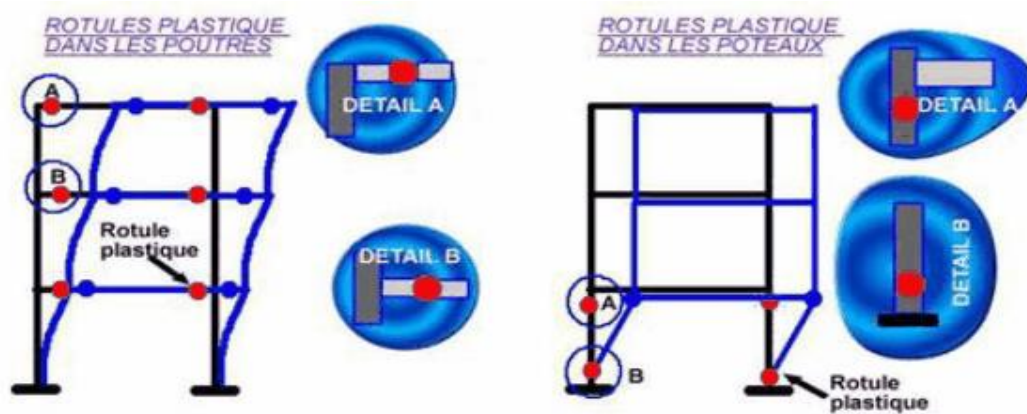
Rotules plastiques au niveau des poteaux et des poutres [27].
